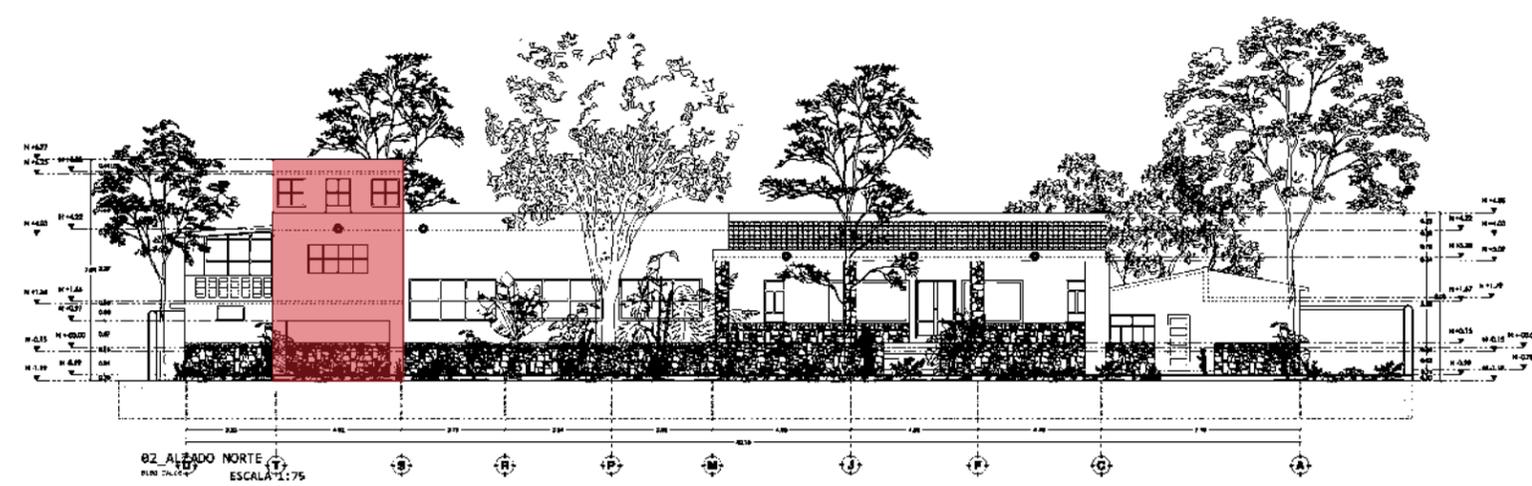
Fachada norte, en la cual se indica con el recuadro rojo la alteración que tuvo la casa.
